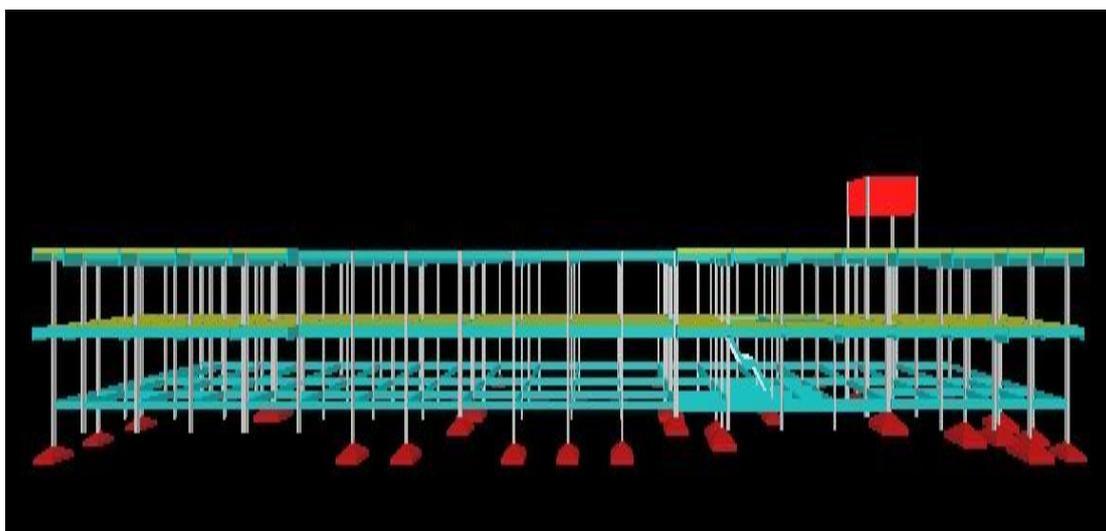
Vista frontal do projeto estrutural com fundação utilizando solo 1
